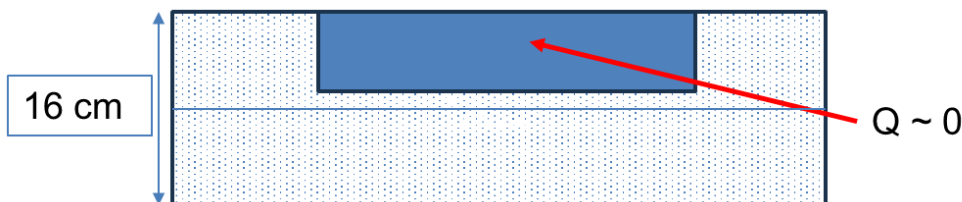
Esquema de aislamiento del pavimento en seco. Fuente: Elaboración propia.
